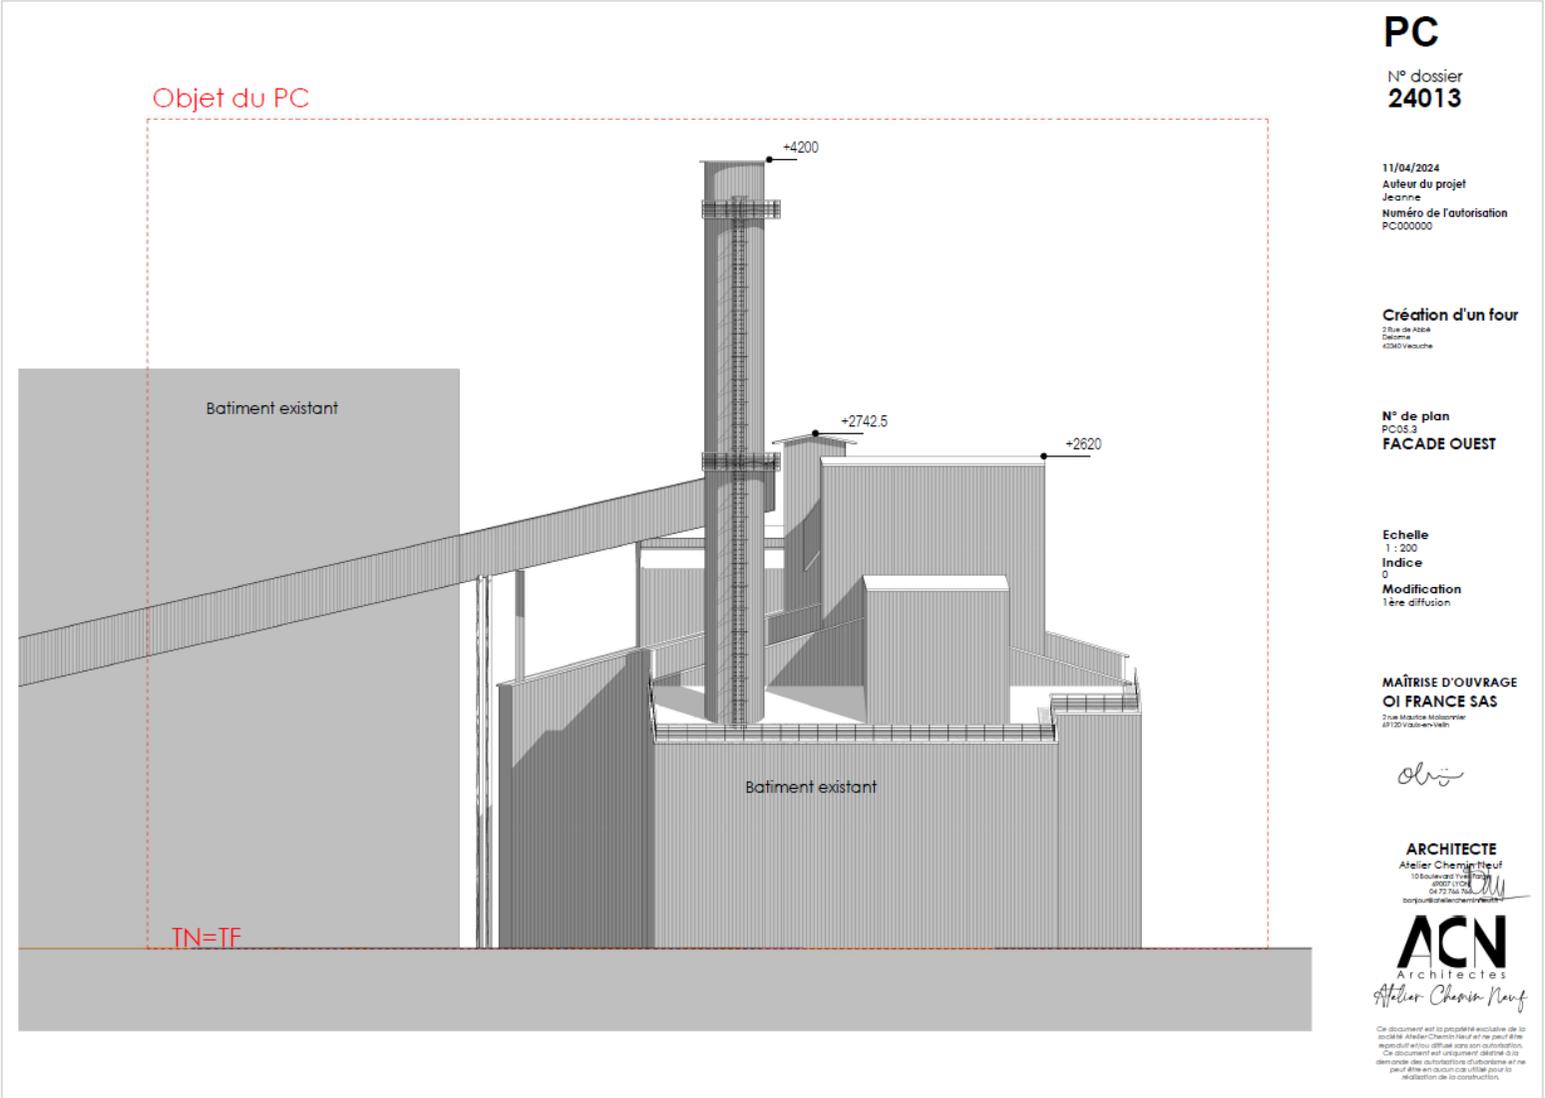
Plan projeté du bâtiment accueillant le four 4 avec réhausse de toiture - Façade Ouest (source : permis de construire lié au rehaussement de toiture)
